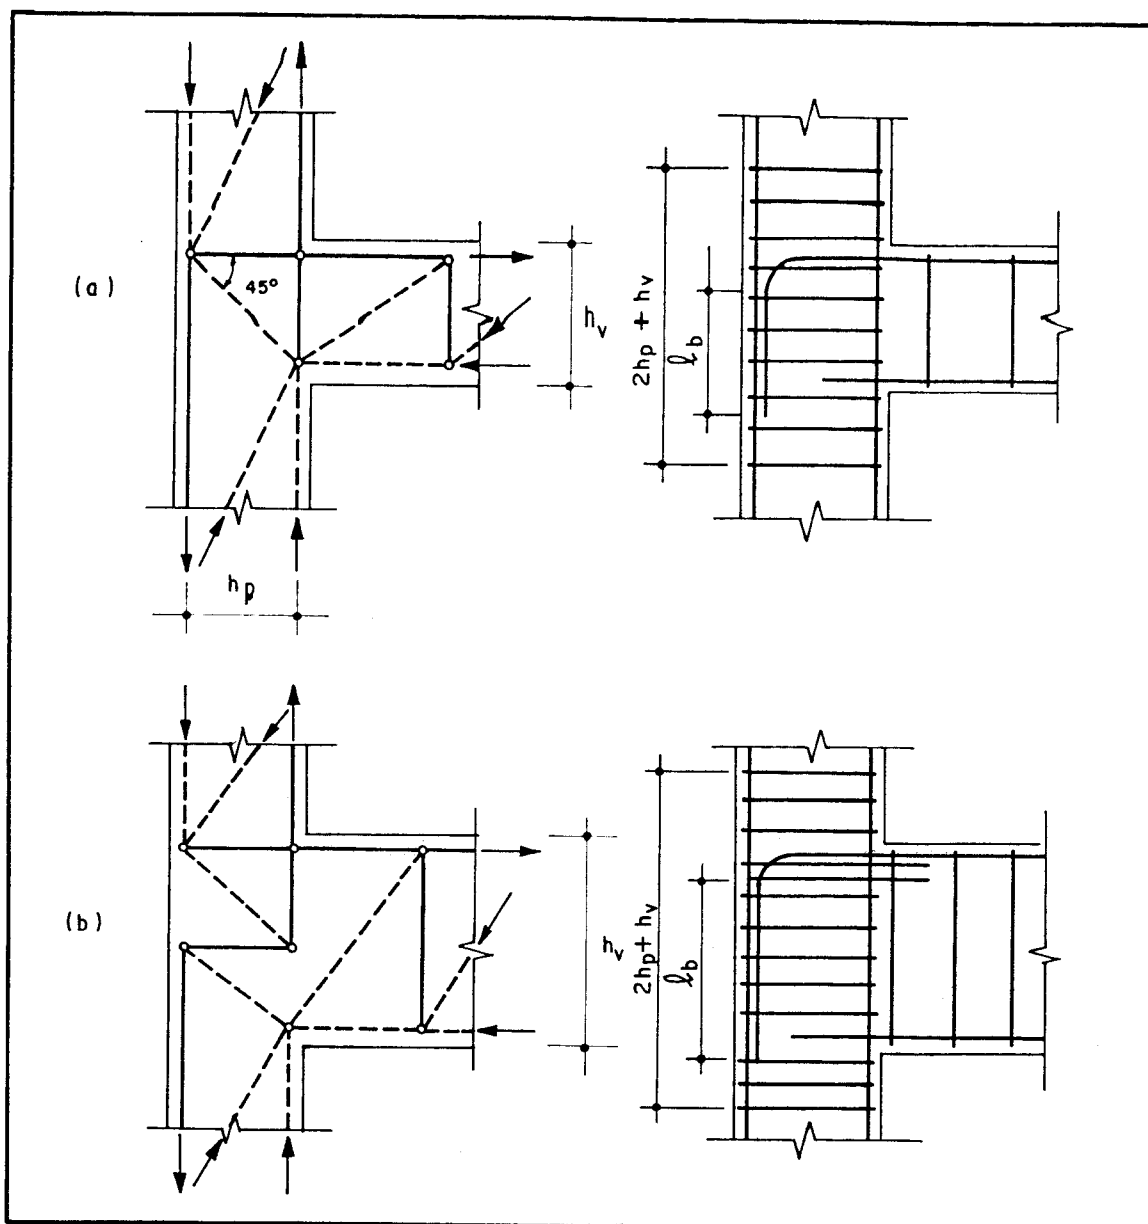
Modelos e detalhamento para ligação viga intermediária - pilar extremo : a) $h_v \approx h_p$, b) $h_v > h_p$ (Adapt. Refs. 9, 15 e 23).
